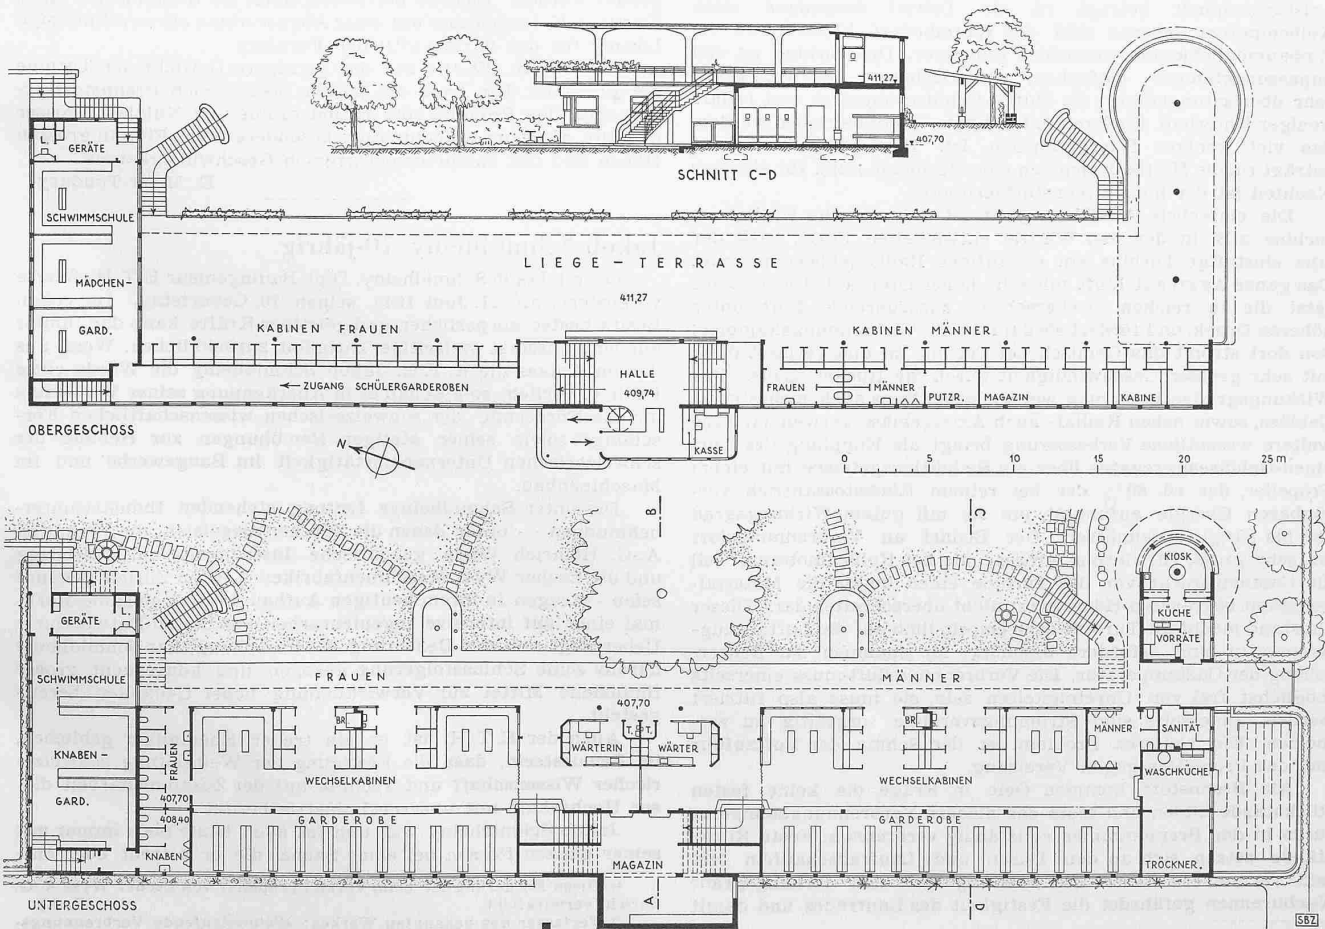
bis 4. Badenstalt Zürich-Wollishofen. Arch. † H. HERTER, Stadtbaumeister. — Grundrisse und Schnitt C-D, Masstab 1:400
